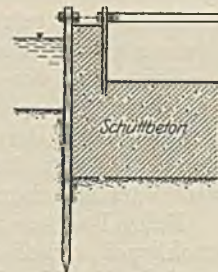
Fangedamm aus Beton zwischen Spundwänden.
